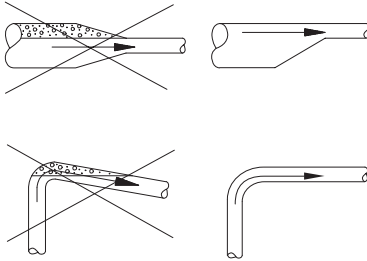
Рекомендованный монтаж трубопровода, чтобы избежать трения и скопления воздуха
